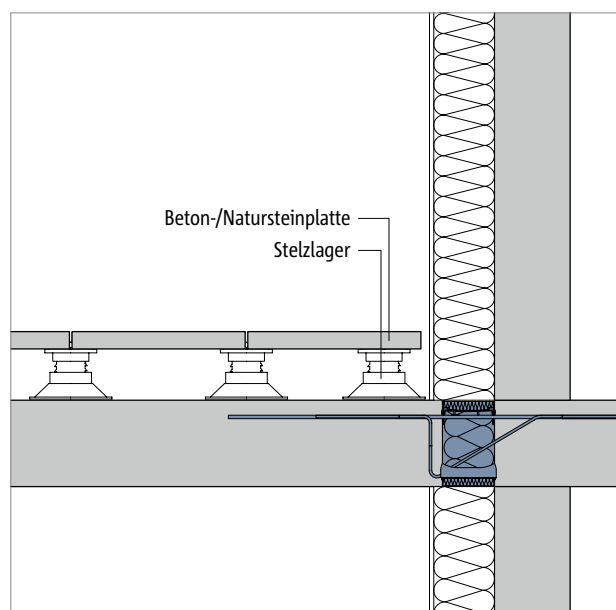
Balkonbelag mit Beton-/Natursteinplatten und Stelzlager
